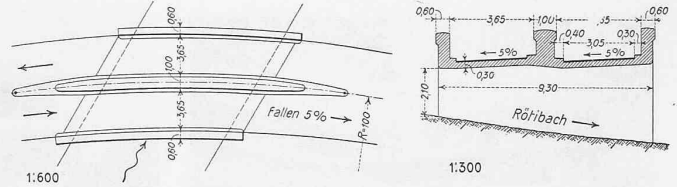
Eisenbetonbrücke über den Rötibach. Abgestufter Fahrbahnquerschnitt wegen geringer Bauhöhe.
